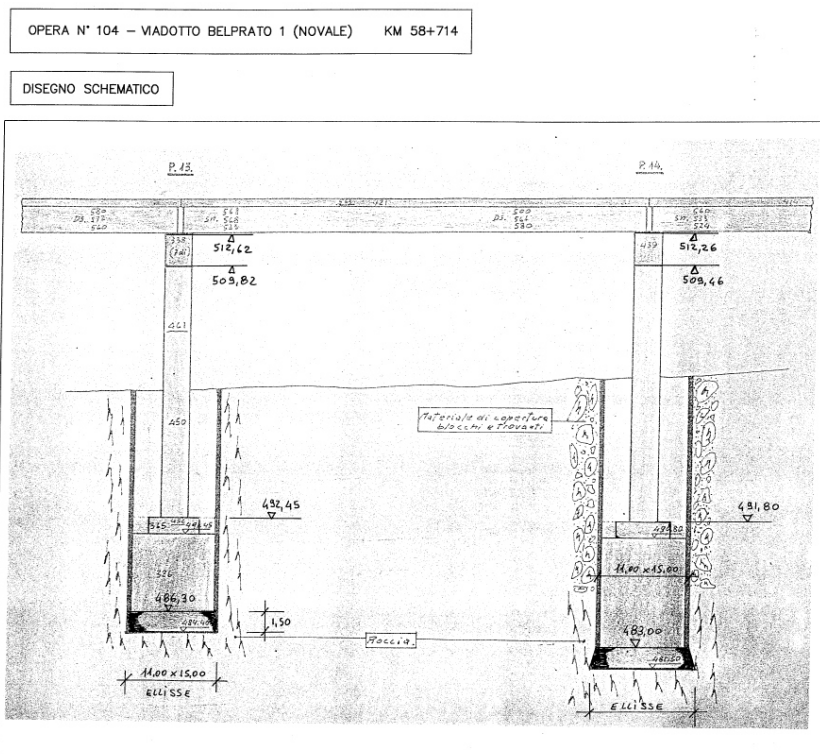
Stralcio dell’elaborato di As-Built – profilo degli scavi di fondazione delle pile del viadotto Belprato (o Novale) dell’A22.
